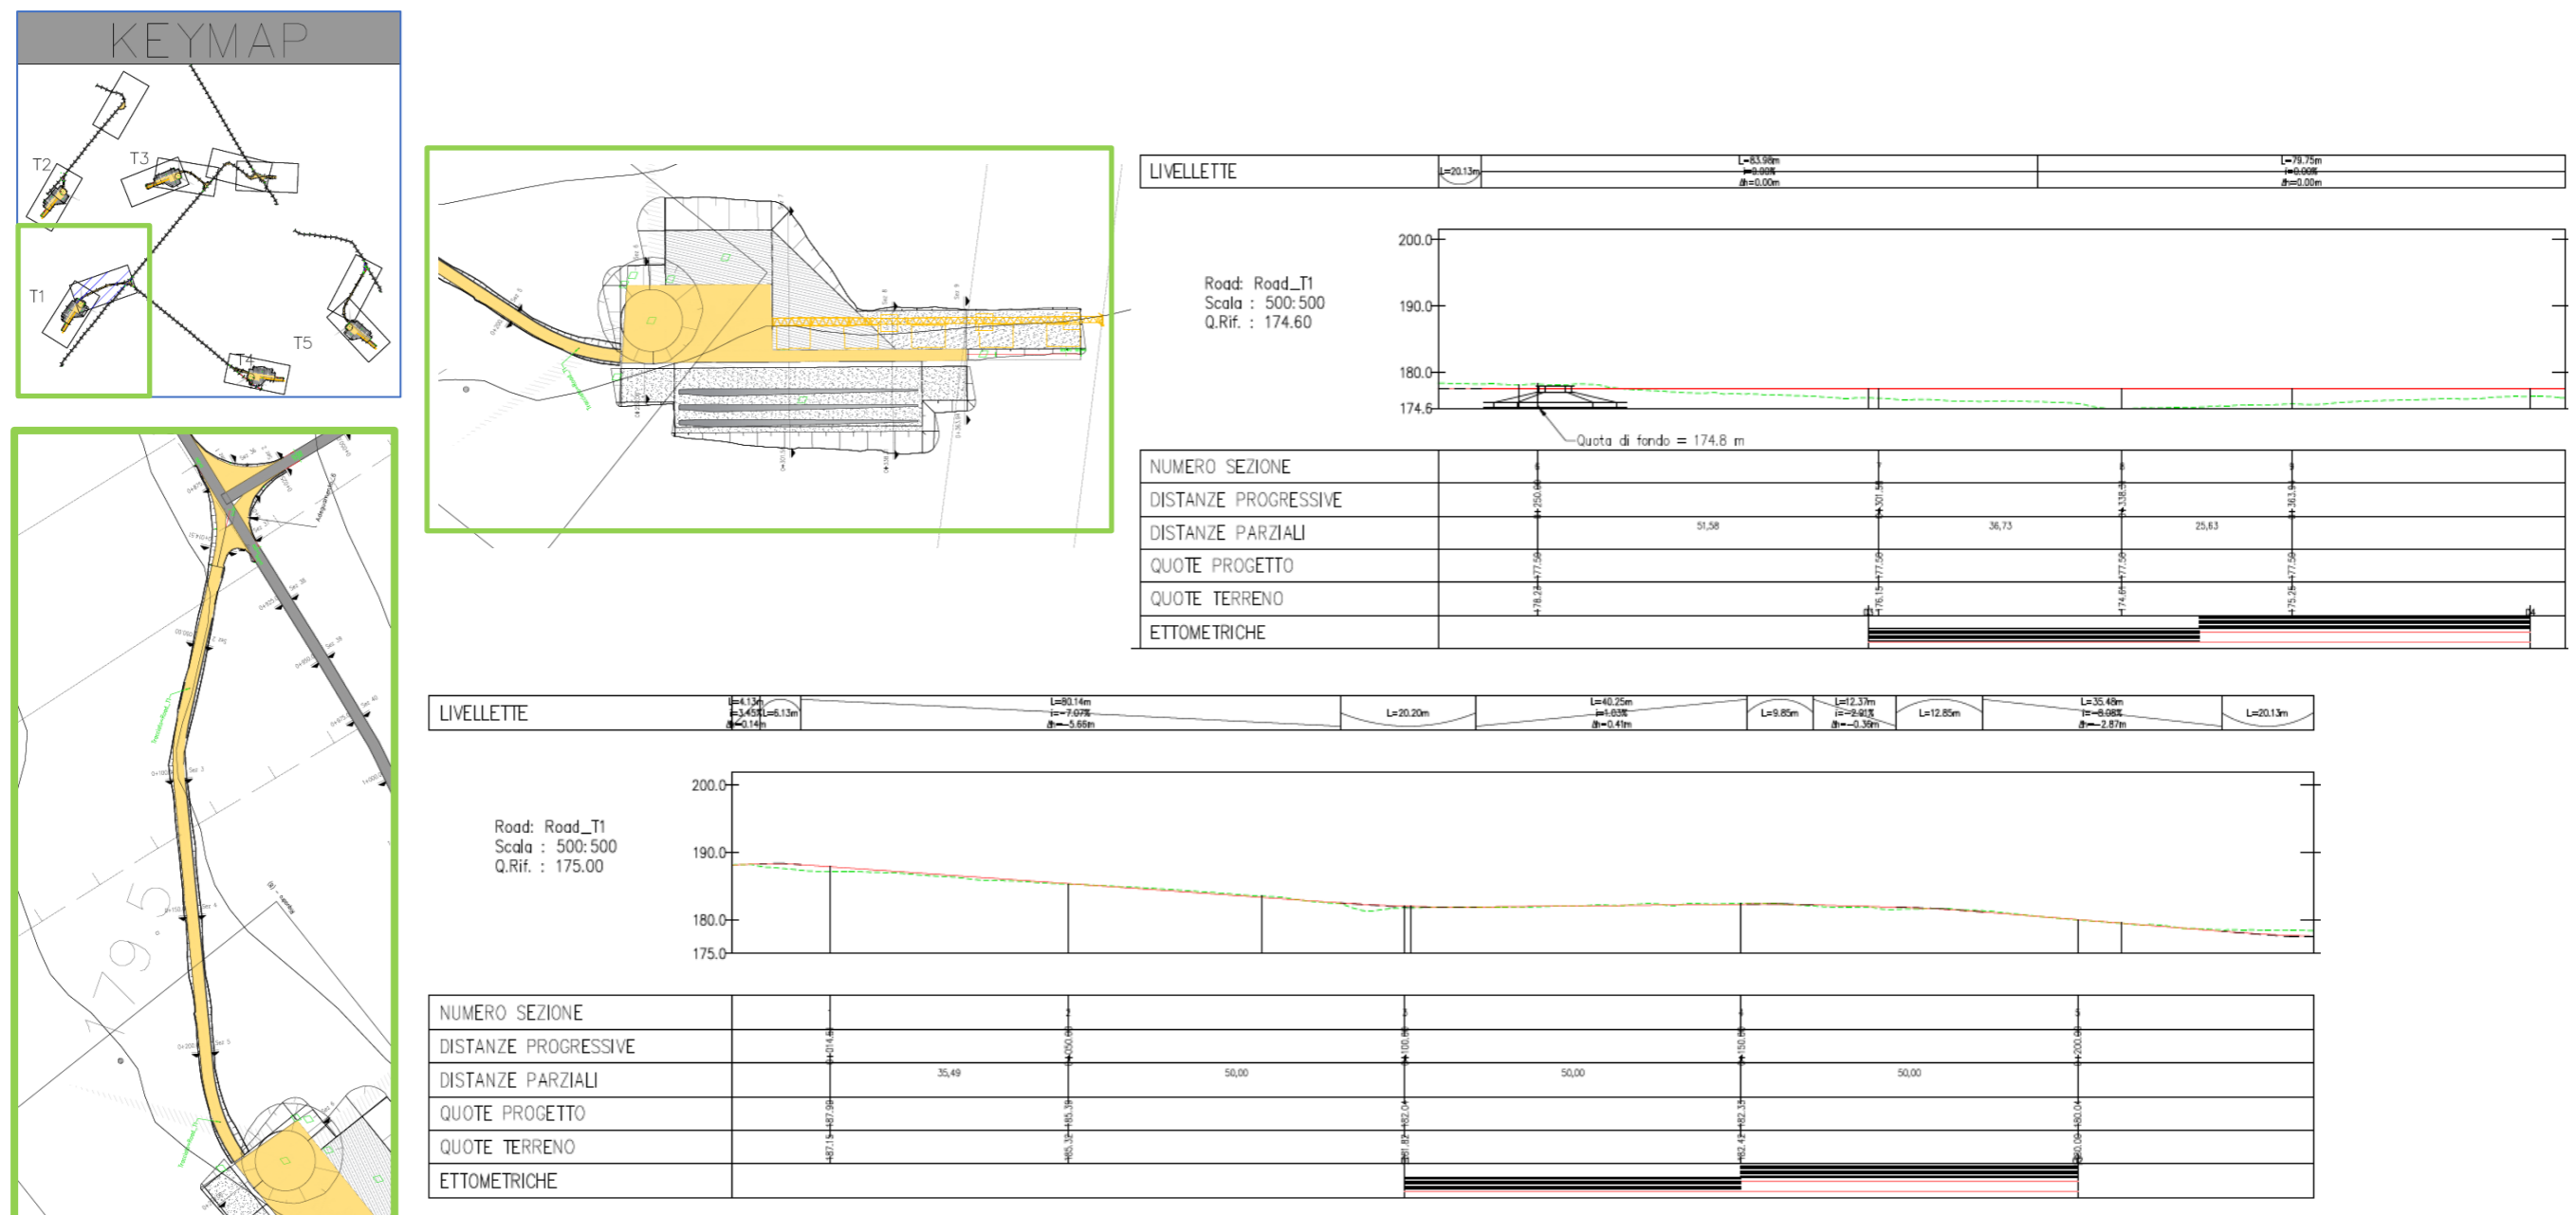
Planimetrie stradali e profili longitudinali\_T1
